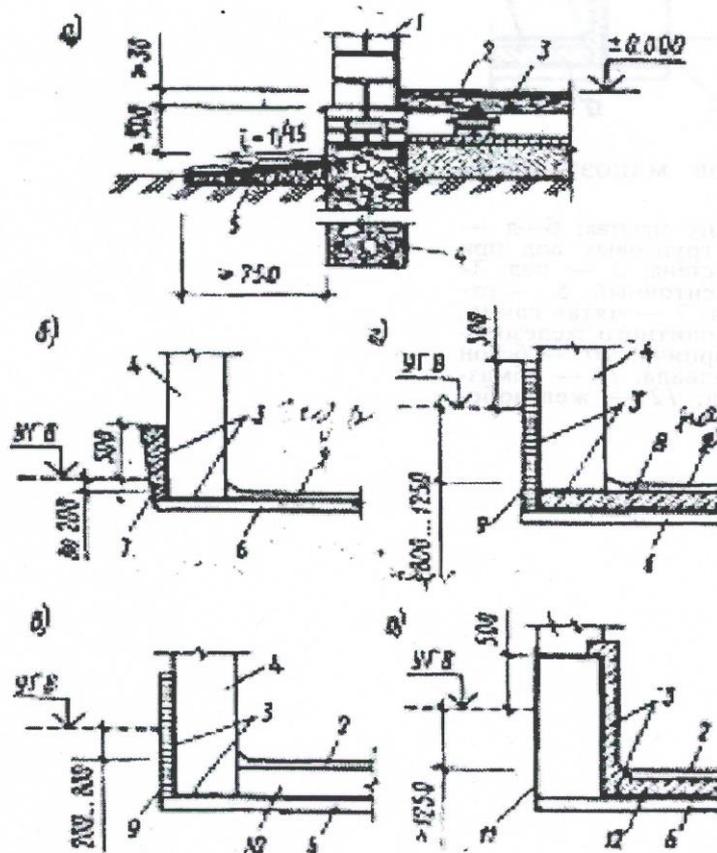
Защита элементов малоэтажных зданий от влаги грунтов:
